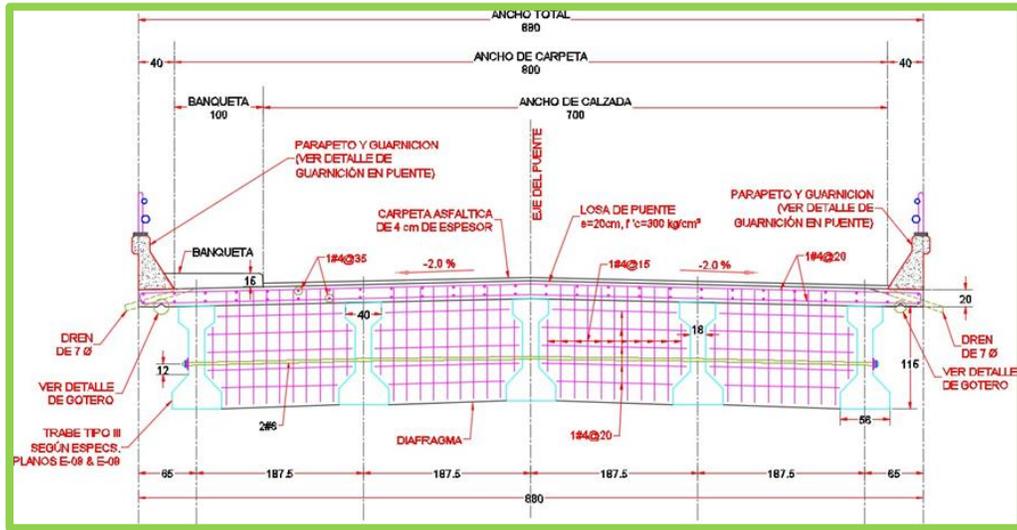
Sección transversal de puente en diáframas, ilustra armado de losa. S/E
